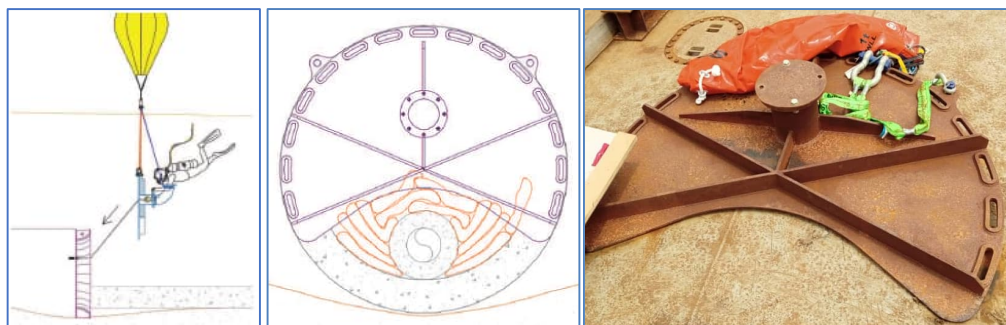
Esempio di Installazione di un Piatto di Chiusura Microtunnel
